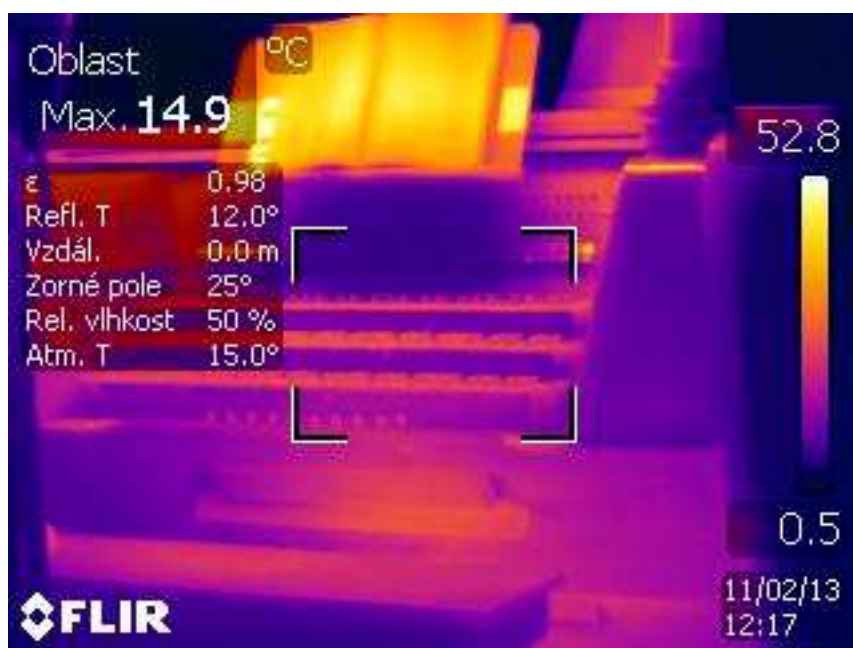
Pohled od pěveckého sboru před instalací panelu
